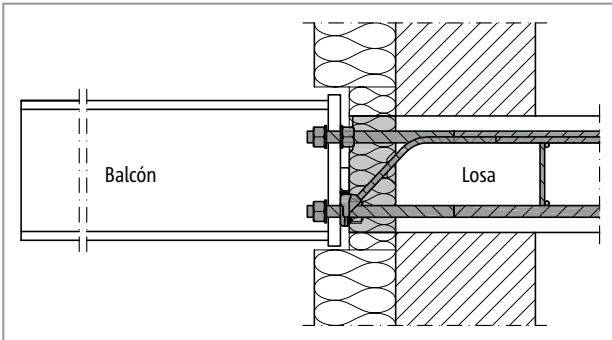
Schöck Isokorb® T tipo SK: Conexión a la losa de hormigón armado; elemento aislante dentro del aislamiento externo
